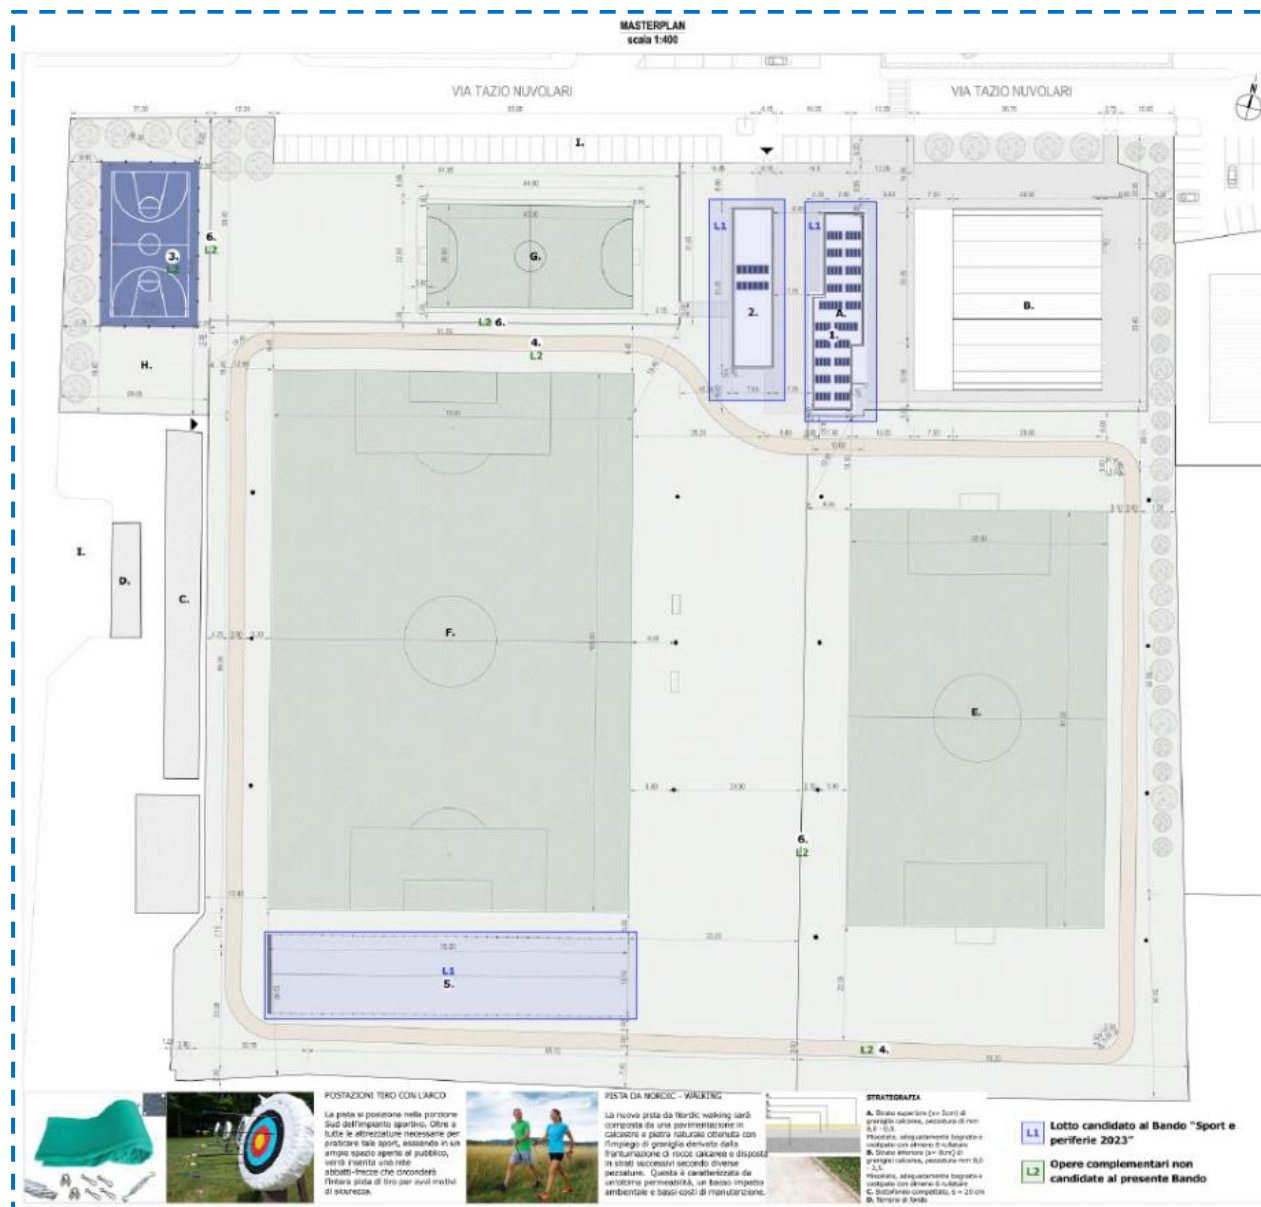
Estratto Tav.A.04.a: Planimetria dello stato di progetto
